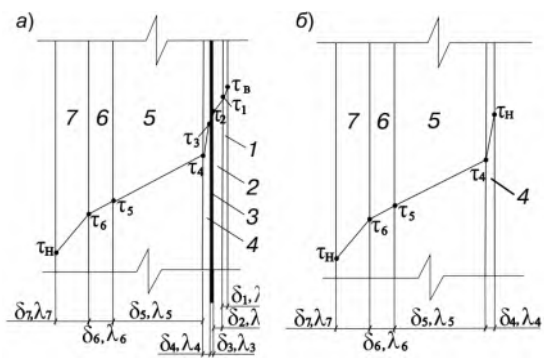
Варианты наружных стеновых конструкций: 1 – гипсокартонный лист; 2 – теплоотражающее покрытие; 3 – воздушная прослойка; 4 – штукатурное покрытие; 5 – кладка из керамического кирпича рядового толщиной 0,38 м; 6 – пенополистирол толщиной 0,05 м; 7 – кладка из керамического кирпича лицевого (толщиной 0,13 м)
